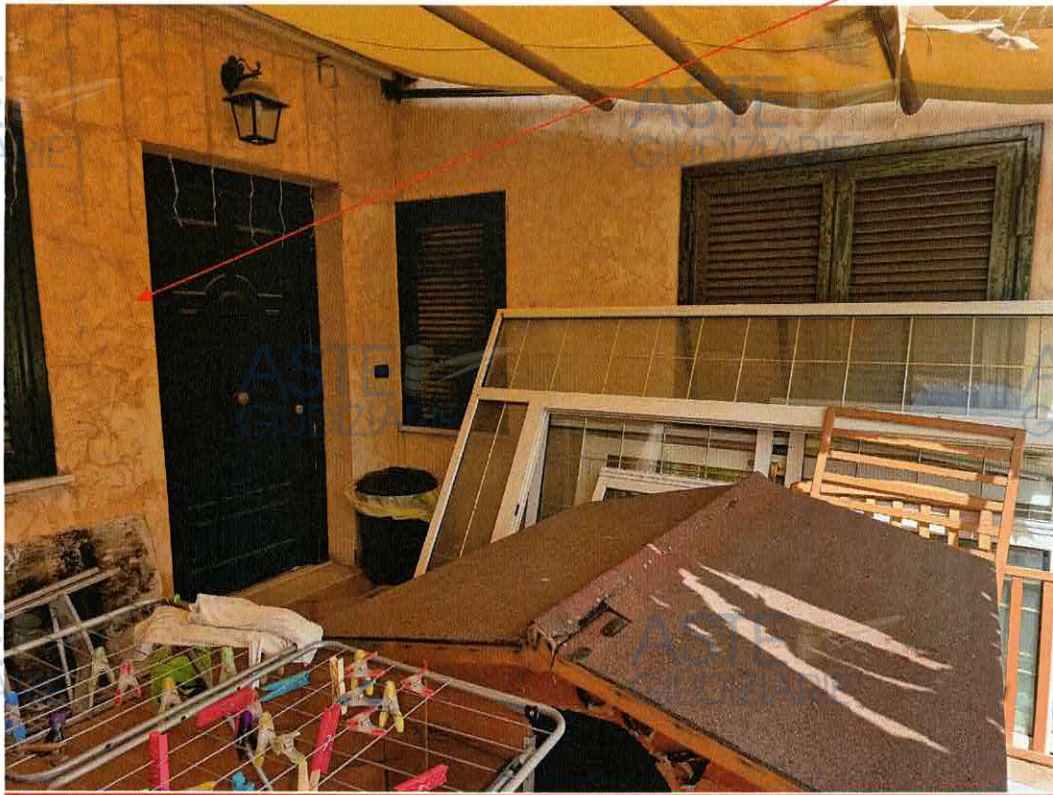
FOTO AMBIENTE ATTIGUO PROSPETTO ESTERNO
